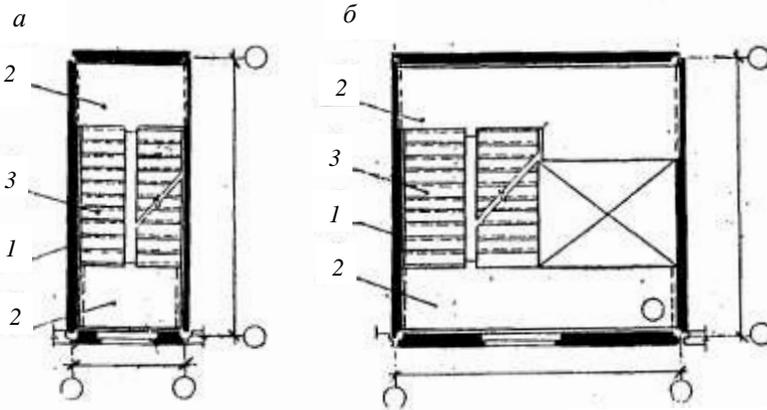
Лестничная клетка бескаркасного здания: *а* — в виде самостоятельной шахты; *б* — в виде лестнично-лифтового узла; 1 — несущая стена; 2 — лестничная площадка; 3 — лестничный марш
